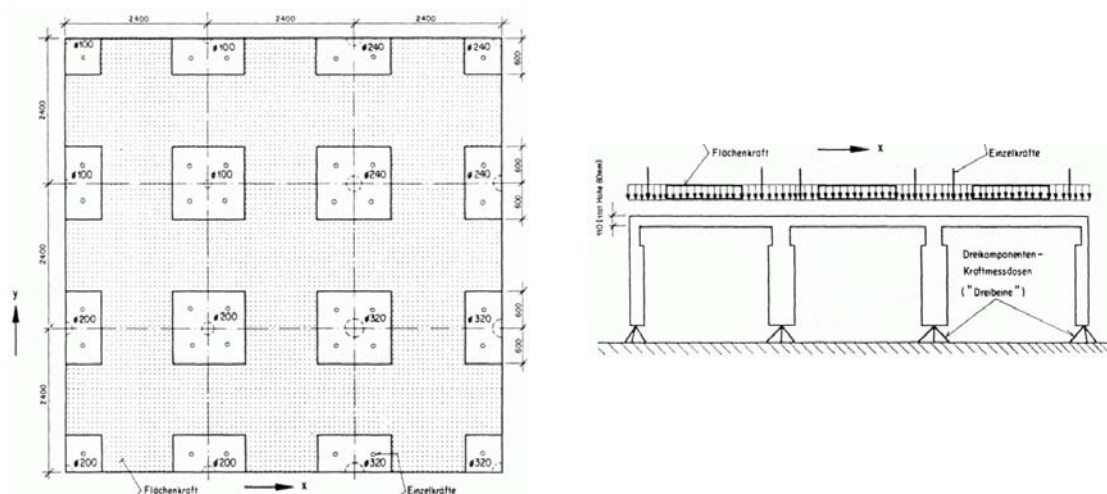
Plancher-dalle à neuf champs testé à l'EMPA [Ladner77]
